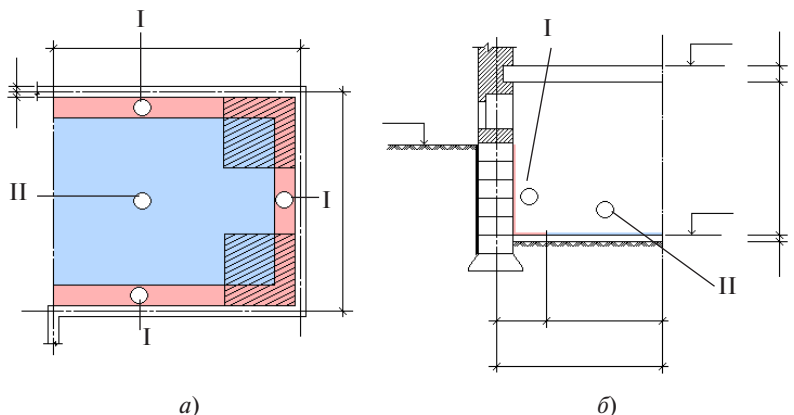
Теплопотери через полы, лежащие на грунте: *а* – план отапливаемой части подвала с нанесенными (с учетом стен по грунту) зонами; *б* – разрез с нанесенными зонами
